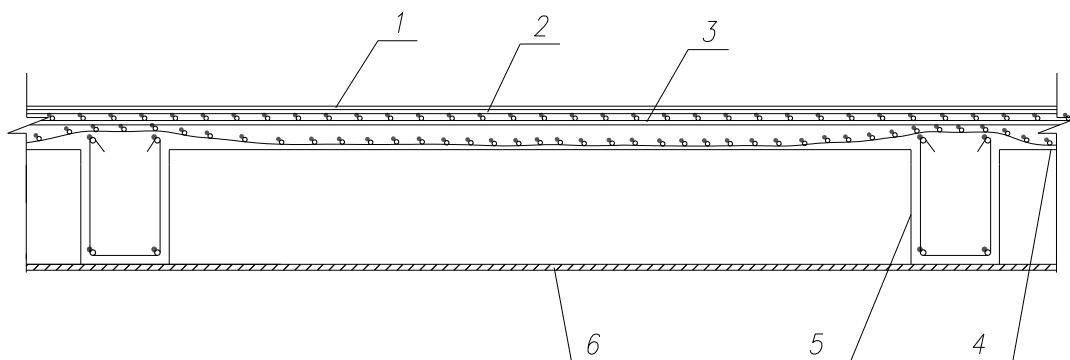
Схема усиления плиты монолитного ребристого перекрытия набетонкой сверху:
